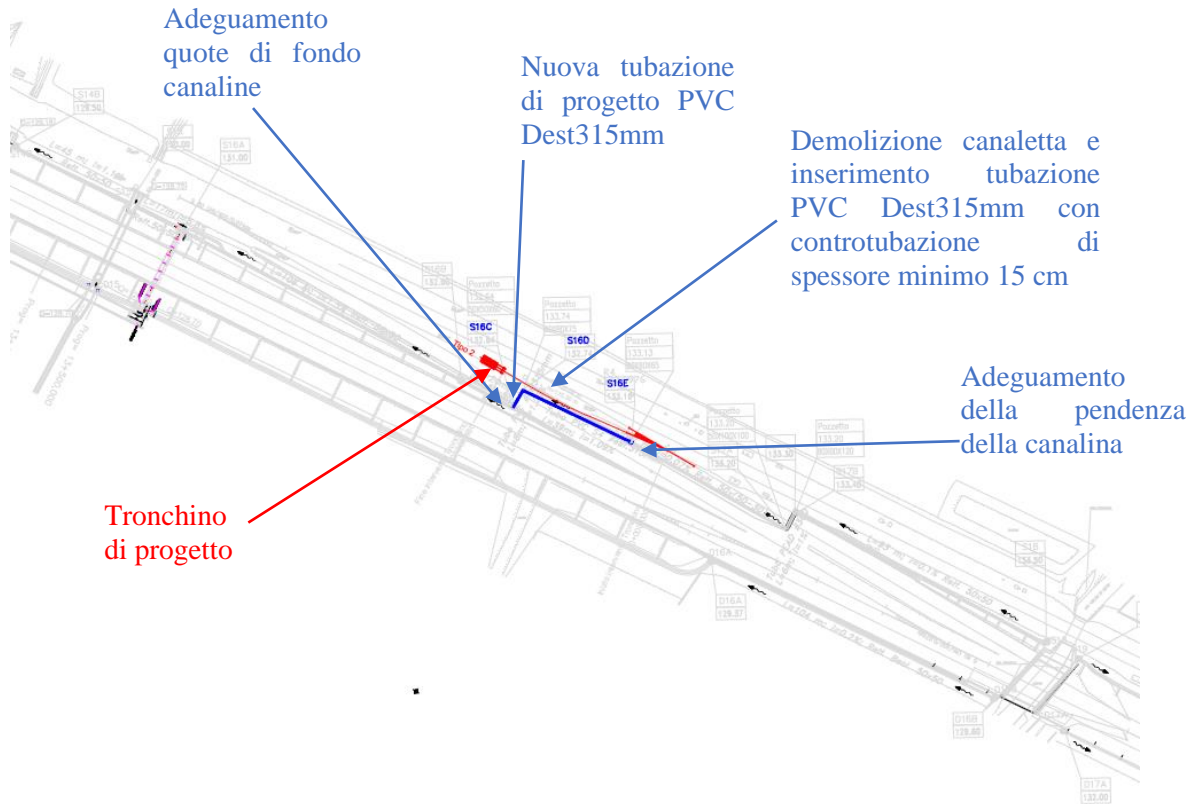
Ubicazione su planimetria del tratto della rete di drenaggio oggetto di adeguamento
